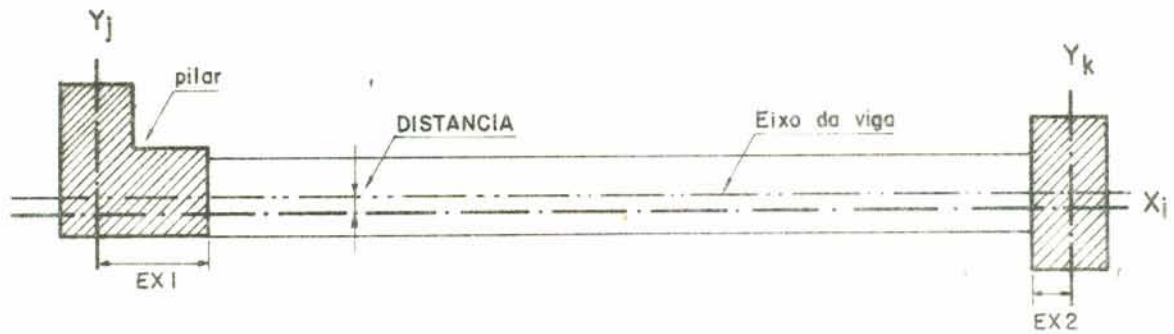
Localização e propriedades da viga - Planta baixa
